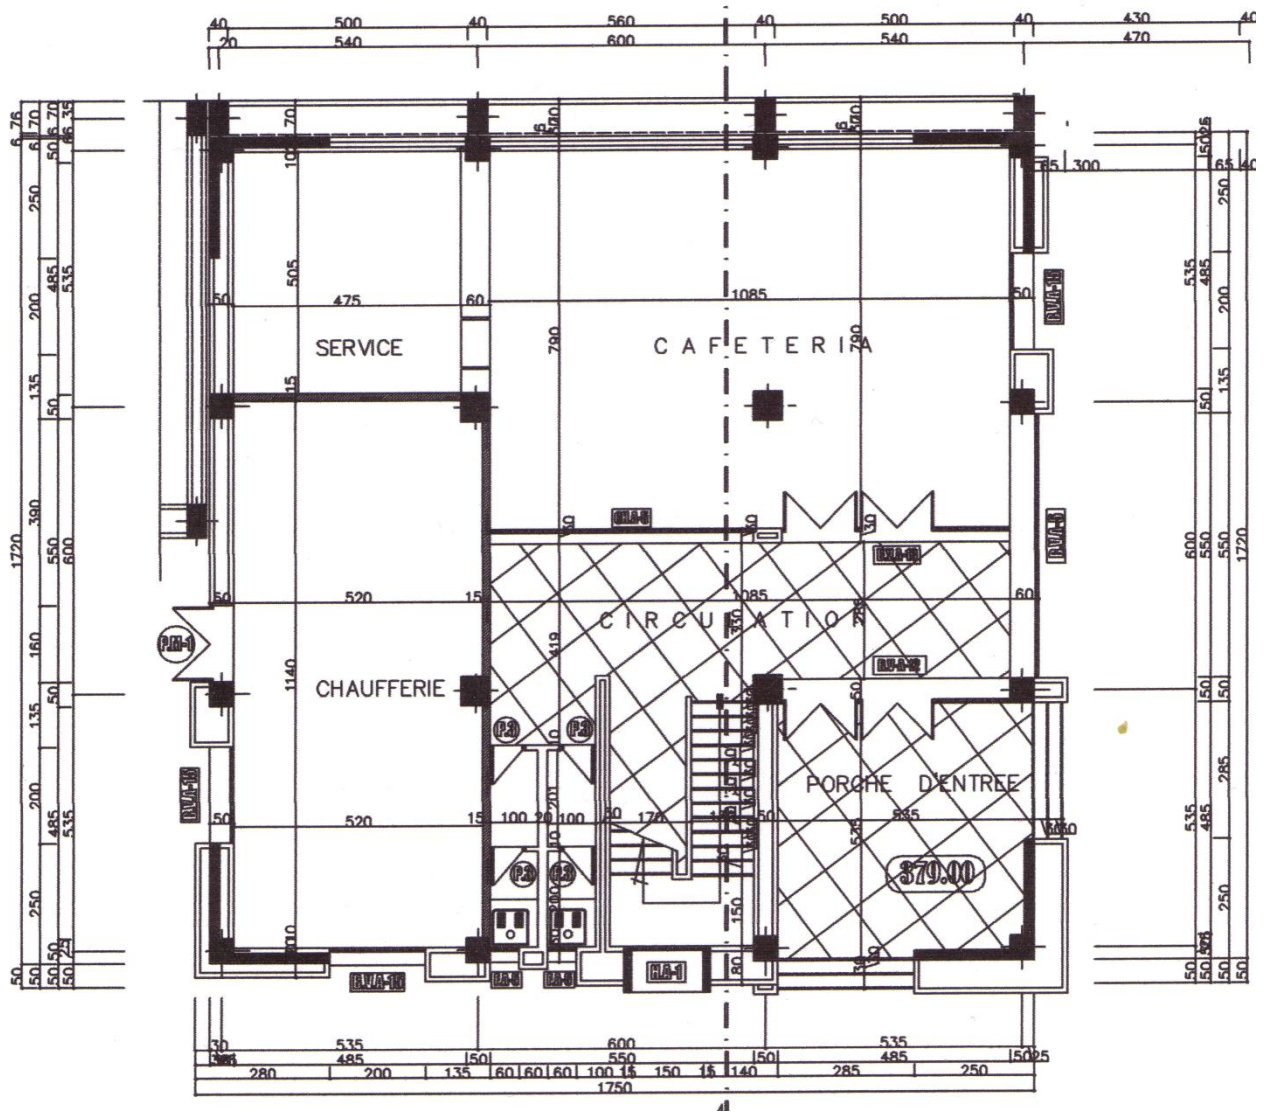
PLAN DE REZ DE CHAUSSEE
